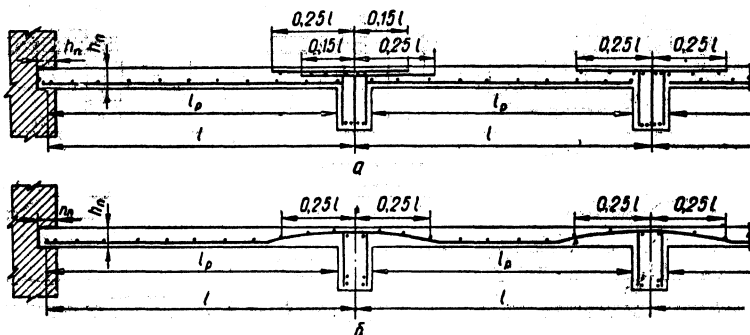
Армирование многопролетных плит сварными сетками:
